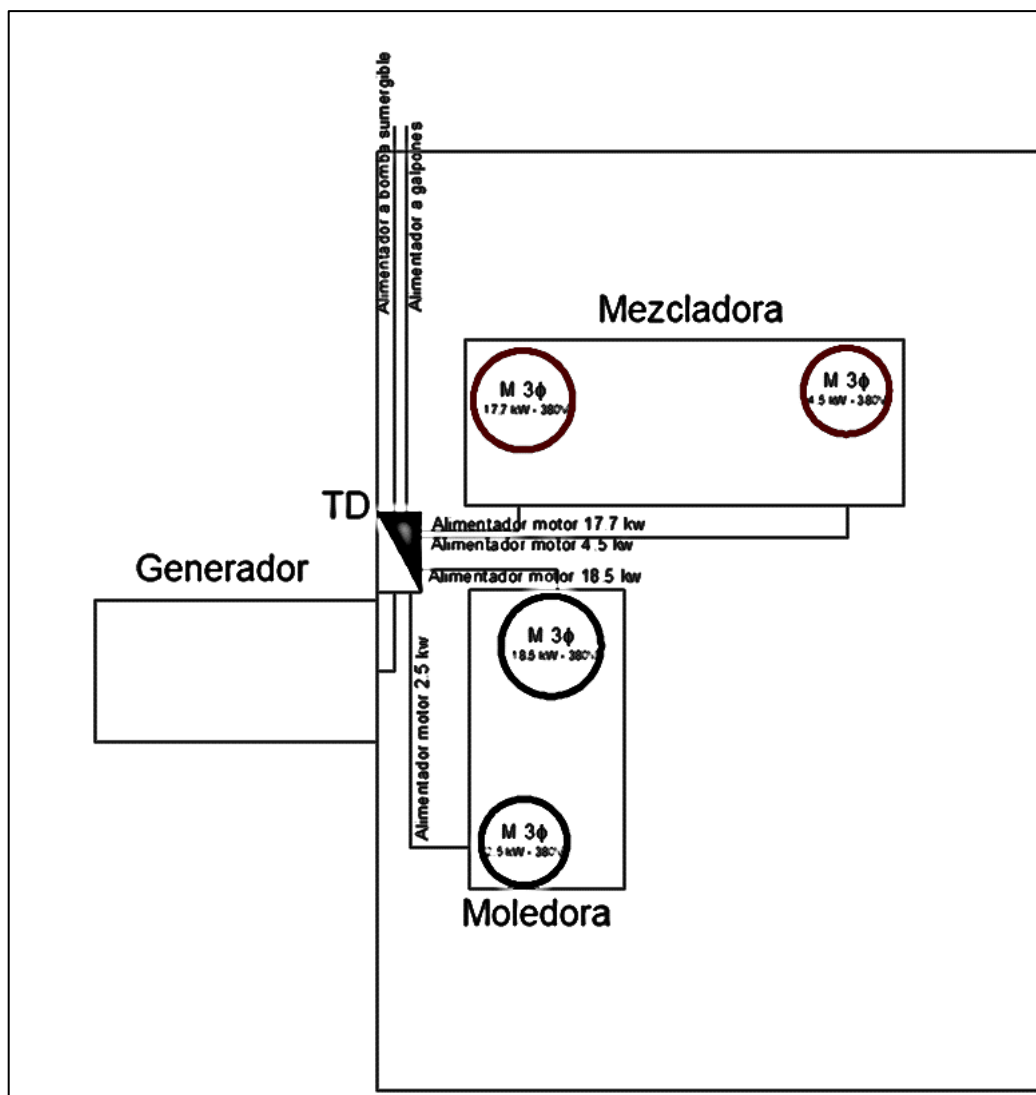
Ubicación de las cargas en la planta de proceso. Fuente: Propia.
